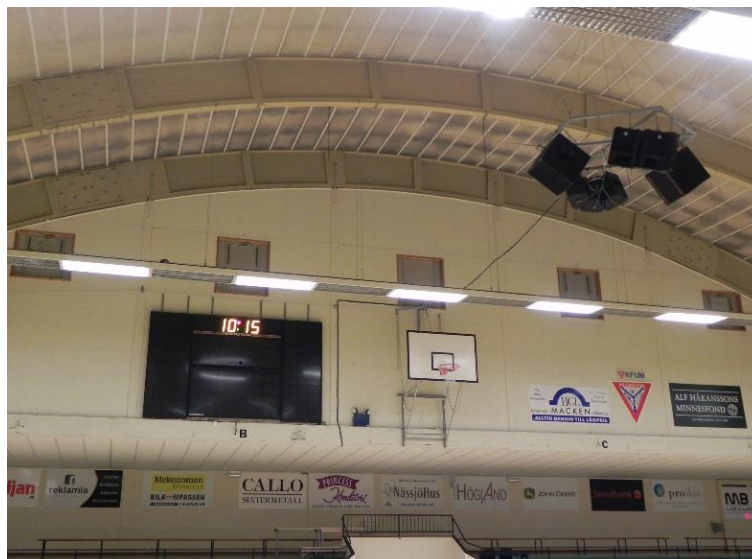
Brandgasventilation i sporthall. Brandgasluckorna är placerade likadant på motstående sida. (Platsbesök 29/2-2014)
